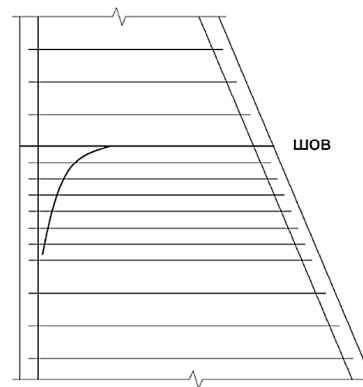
Принципиальная схема армирования подпорной стены в зоне горизонтального межблочного шва
